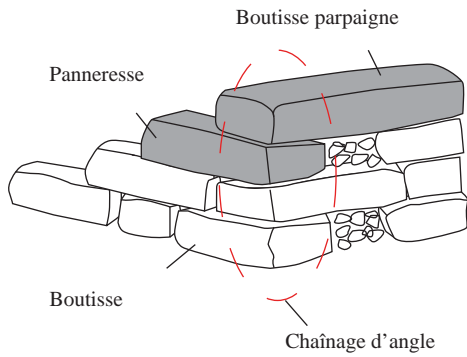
Chaînage d'angle de mur en pierres sèches © d'après C. Lassure
